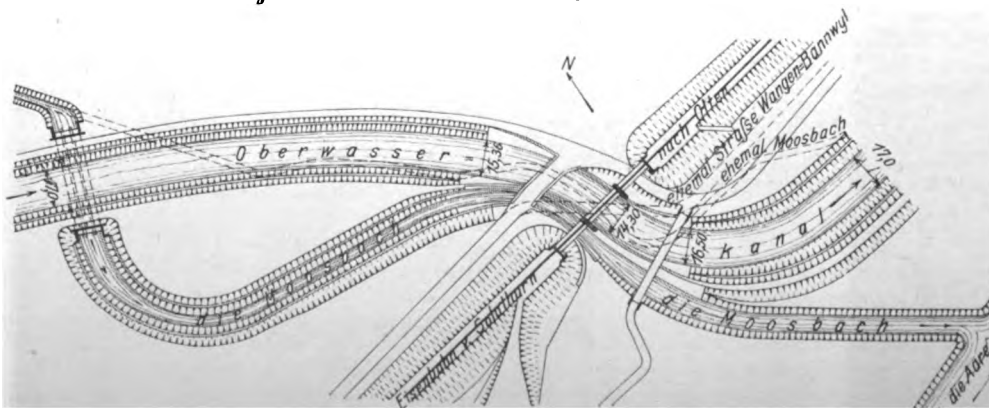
Lageplan des Kanals an der Eisenbahnbrücke.
